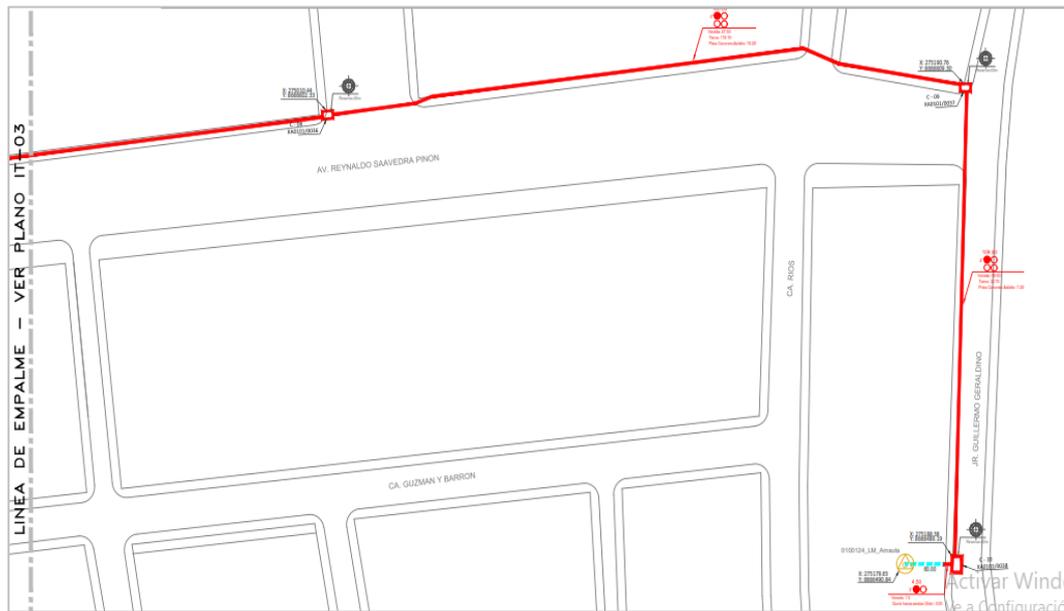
Plano de instalación de F.O - canalizado/site Amauta
